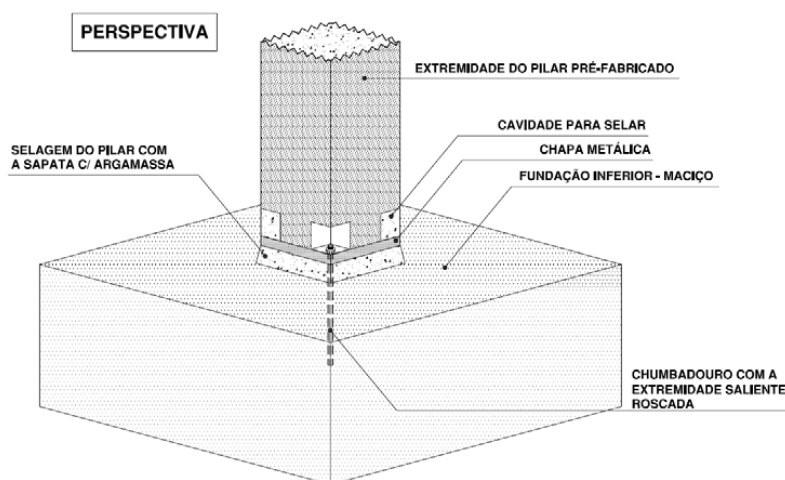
Ligação pilar – fundação com ferrolhos aparafusados (retirado de (REGUENGO, 2010))
